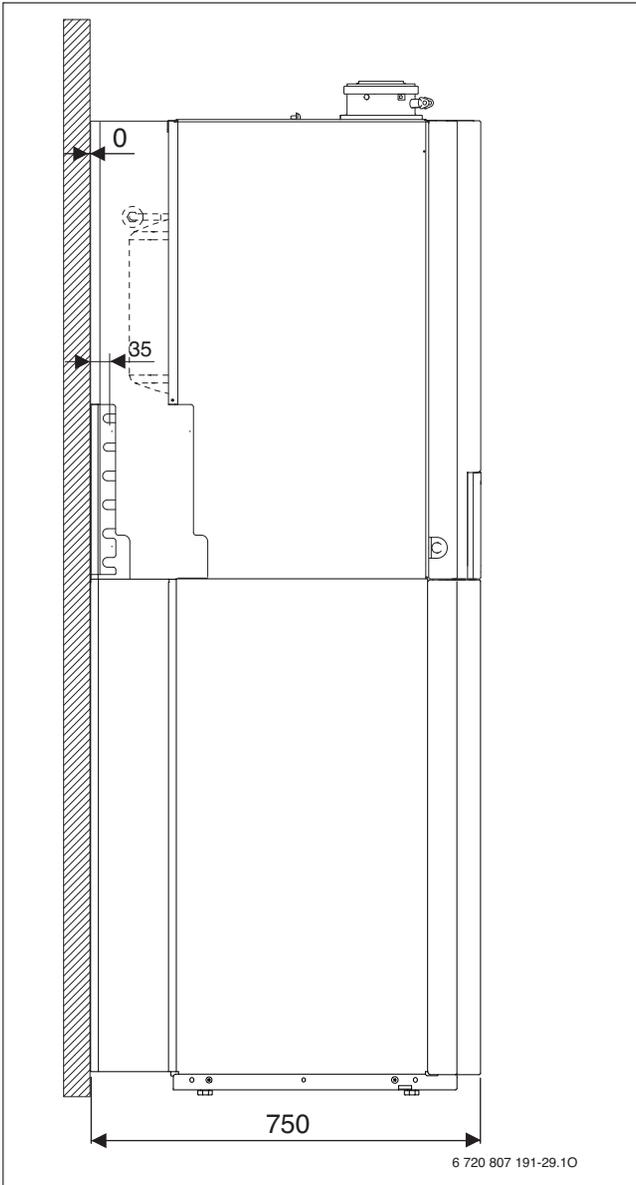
Anschlussmaße für GB172-.. T210SR V2 mit Anschluss-Set seitlich links/rechts mit Blende (Zubehör Nr. 1673/1674) (Maße in mm)
